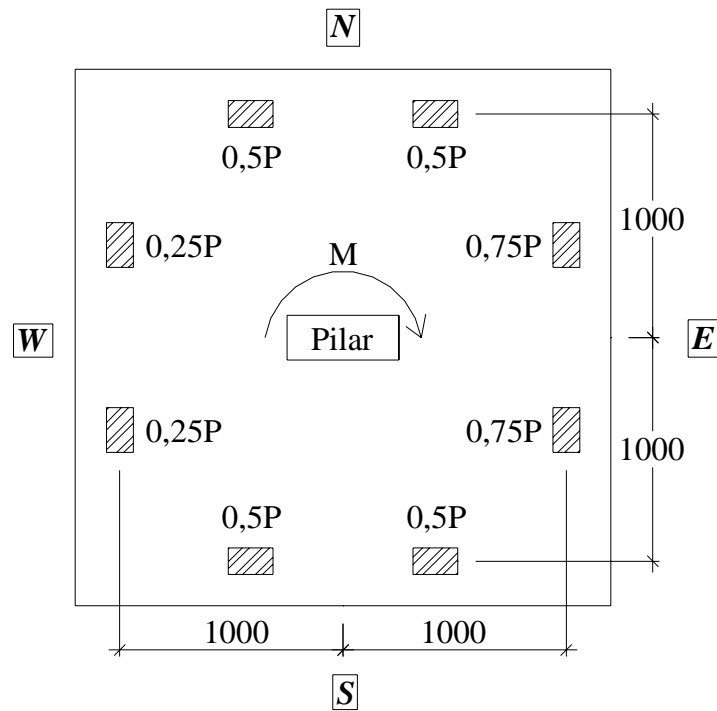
Carregamento das lajes L12 e L13 (dimensões em mm)
